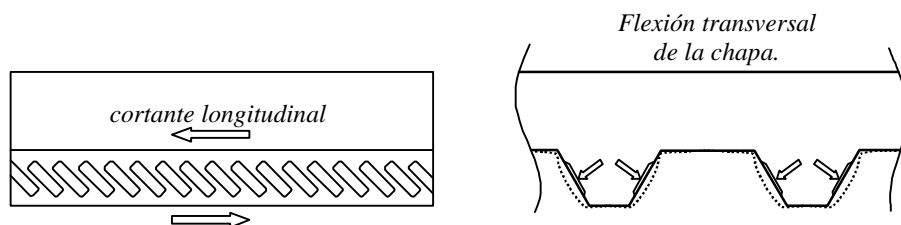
Flexión transversal de la chapa provocada por el deslizamiento longitudinal
